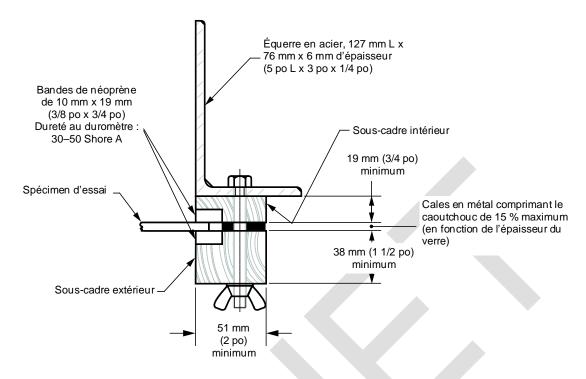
Détail de la coupe A-A — Spécimen d'essai correctement fixé [> 3 mm (1/8 po)]
